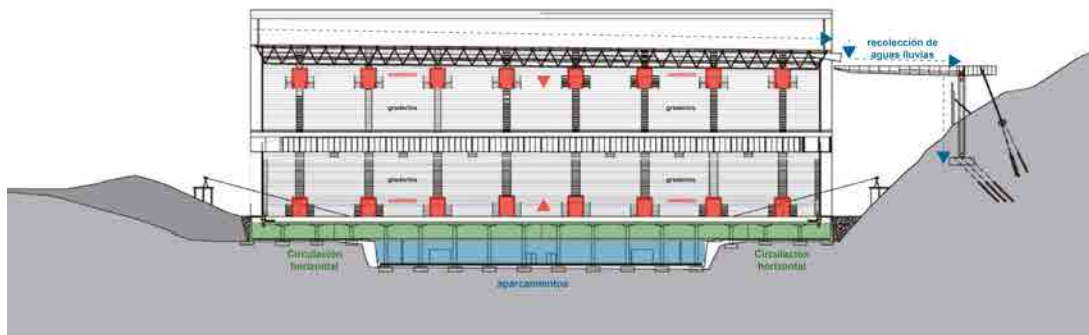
Sección Longitudinal. Fuente: Apuntes sobre el Estadio de Braga, Ricardo Merí de la Maza. Elaboración: Autores.
